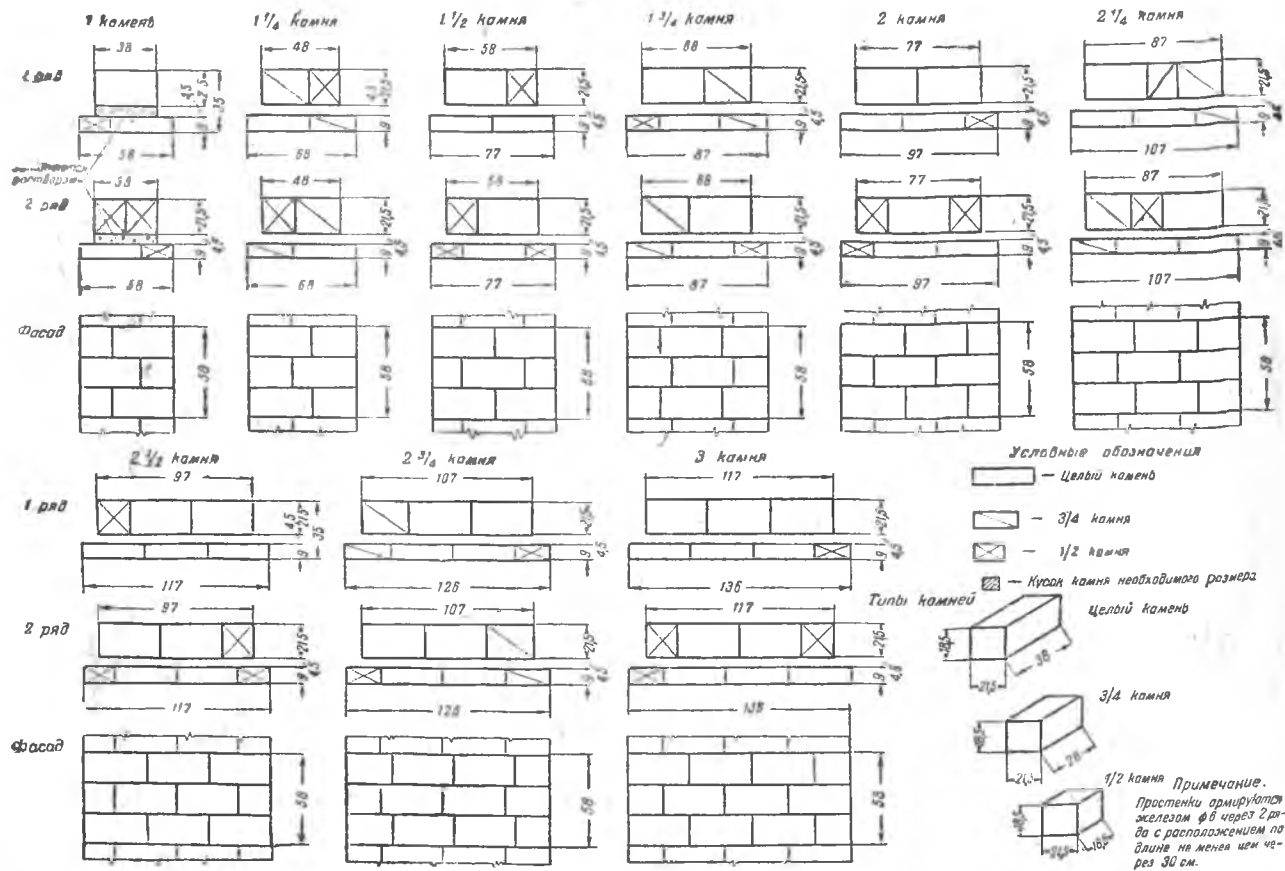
Стены с воздушным прослойком из разных блоков. Кладка простенков
